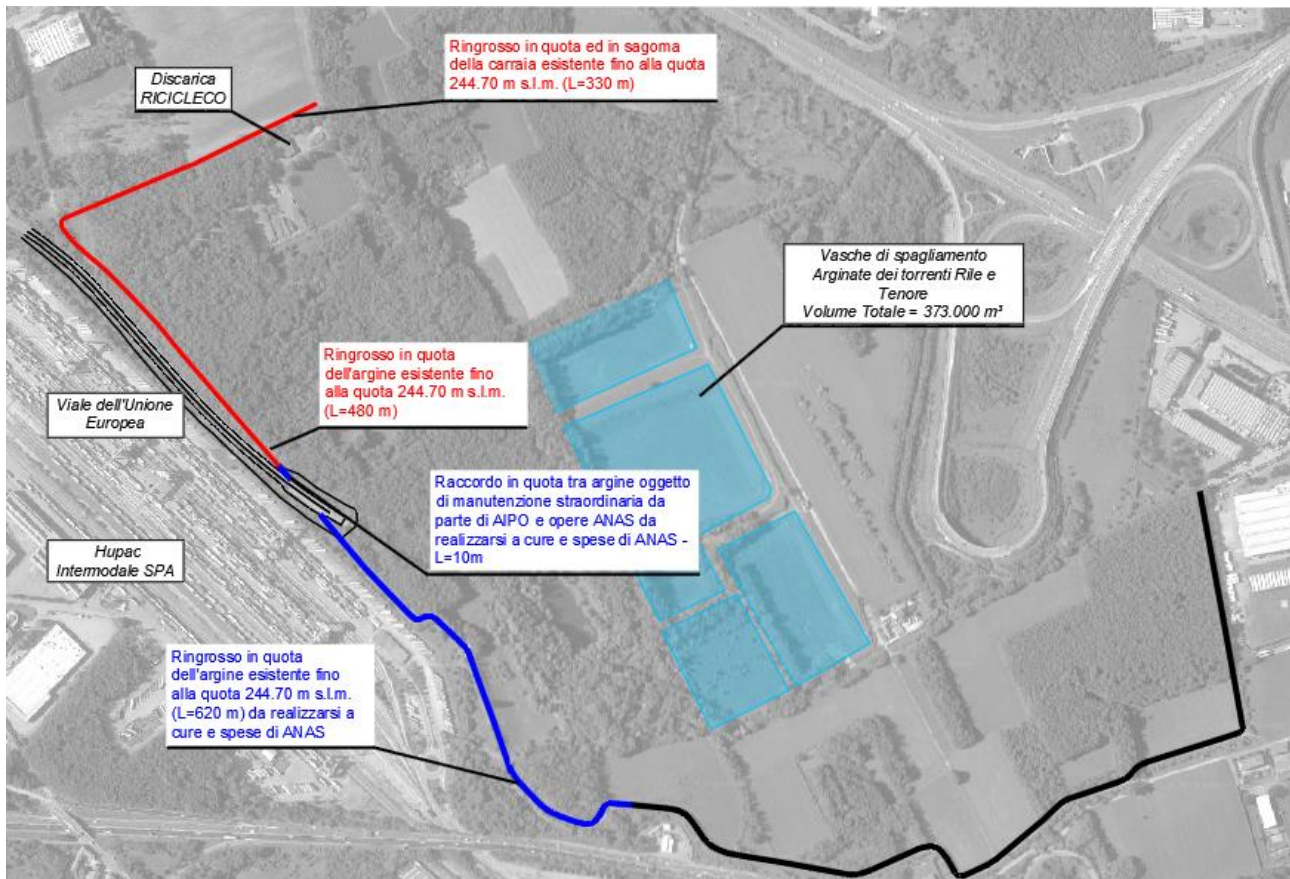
MASTERPLAN DELLE OPERE IN PROGETTO
